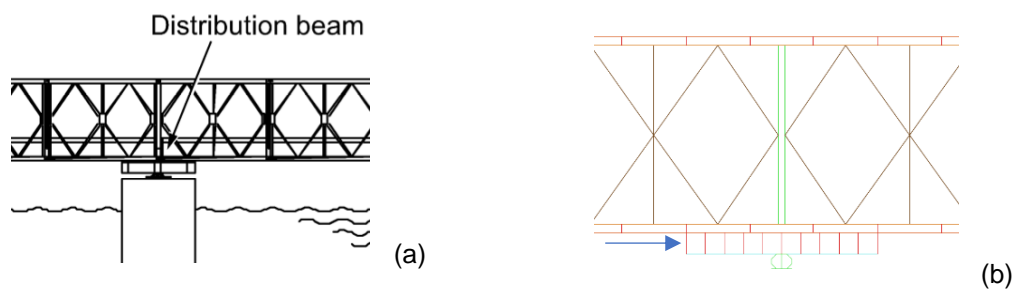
a) Viga de distribuição segundo Mabey Bridge (2014) e b) Modelo de análise (ligações no plano da seta)
